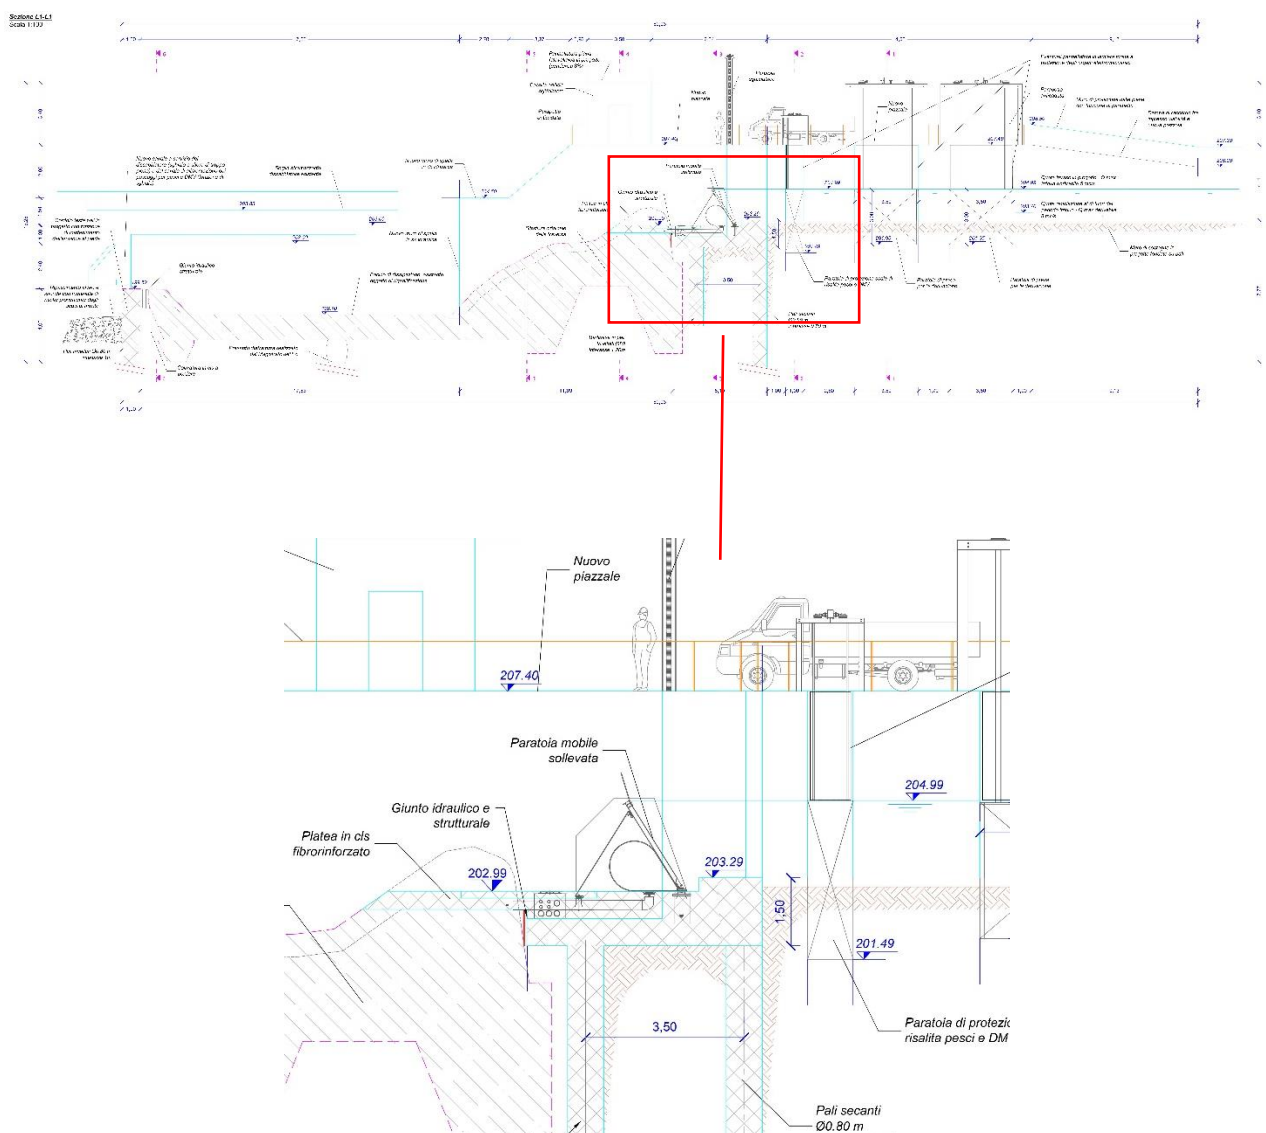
particolare estratto dalle tavole di progetto dell'intervento di scapitozzatura della traversa esistente
